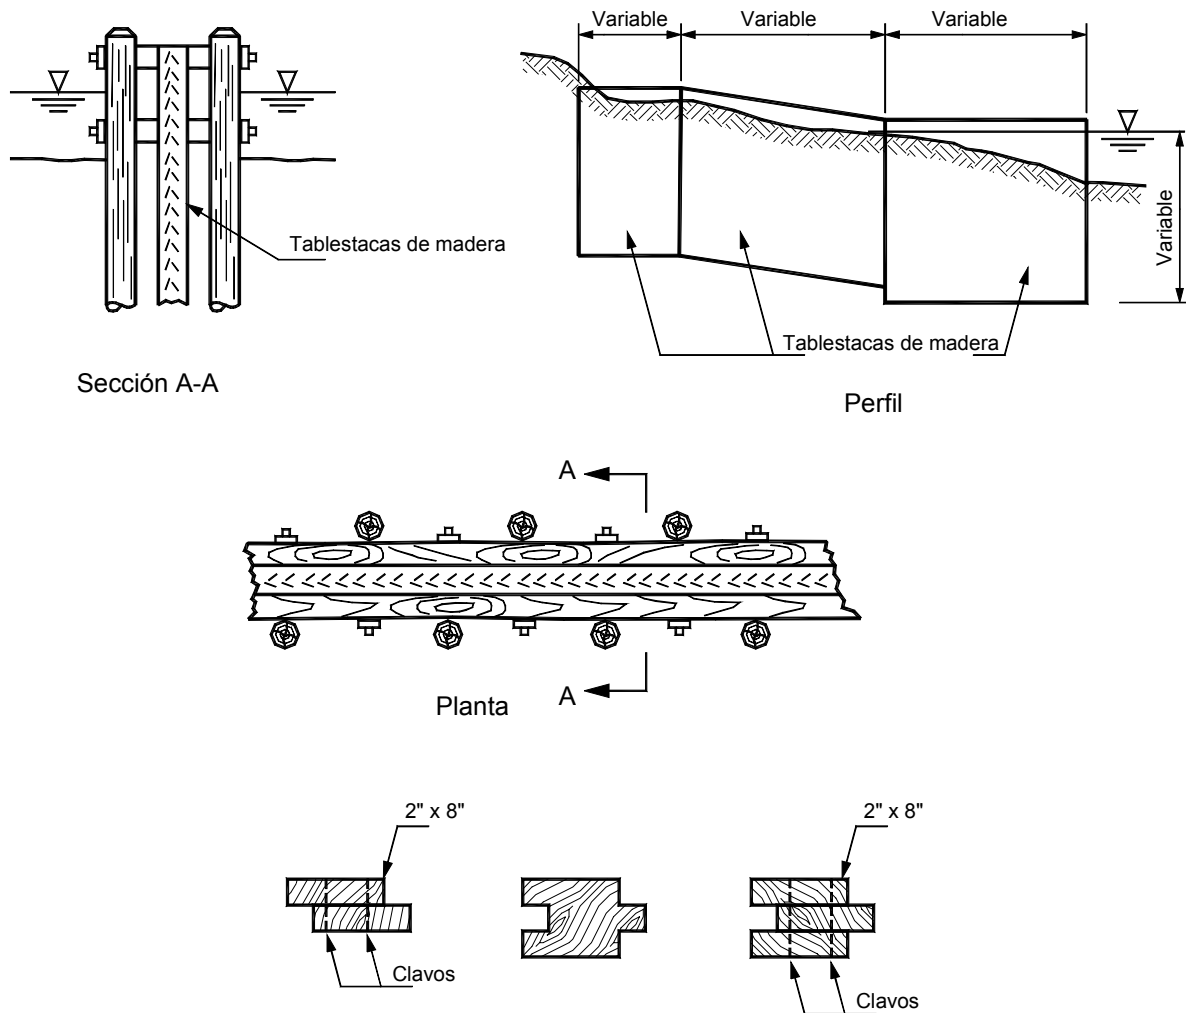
Esquema de espigón marino en pilotes de madera.
